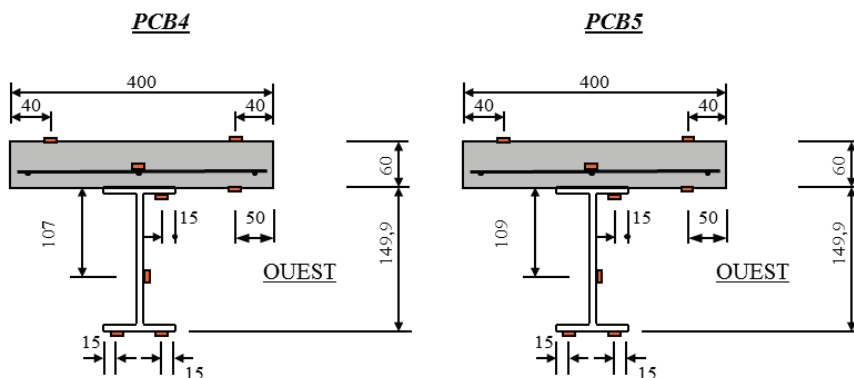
Position des jauges de déformation pour les poutres mixtes PCB4 et PCB5 (dimensions en mm)
